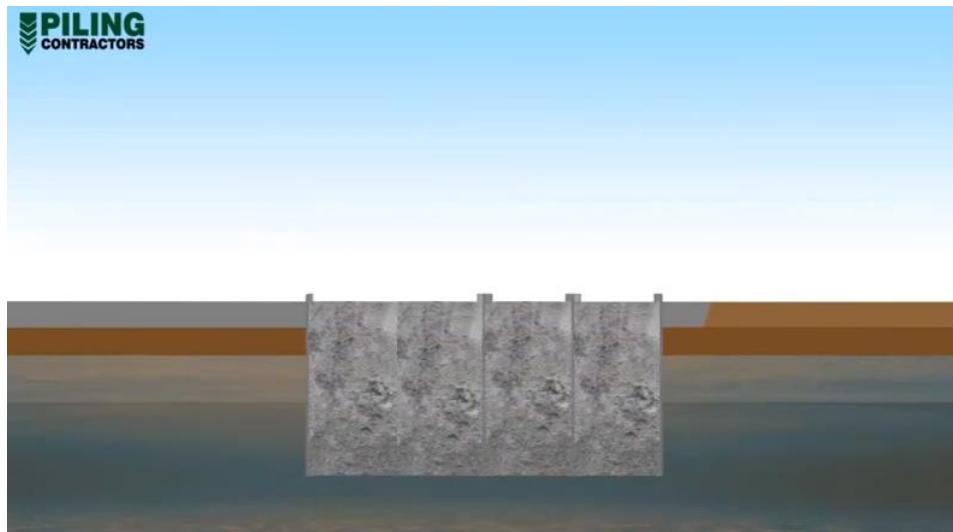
Unión de pantallas terminadas (Diaphragm Wall Construction Methodology, 2014)
